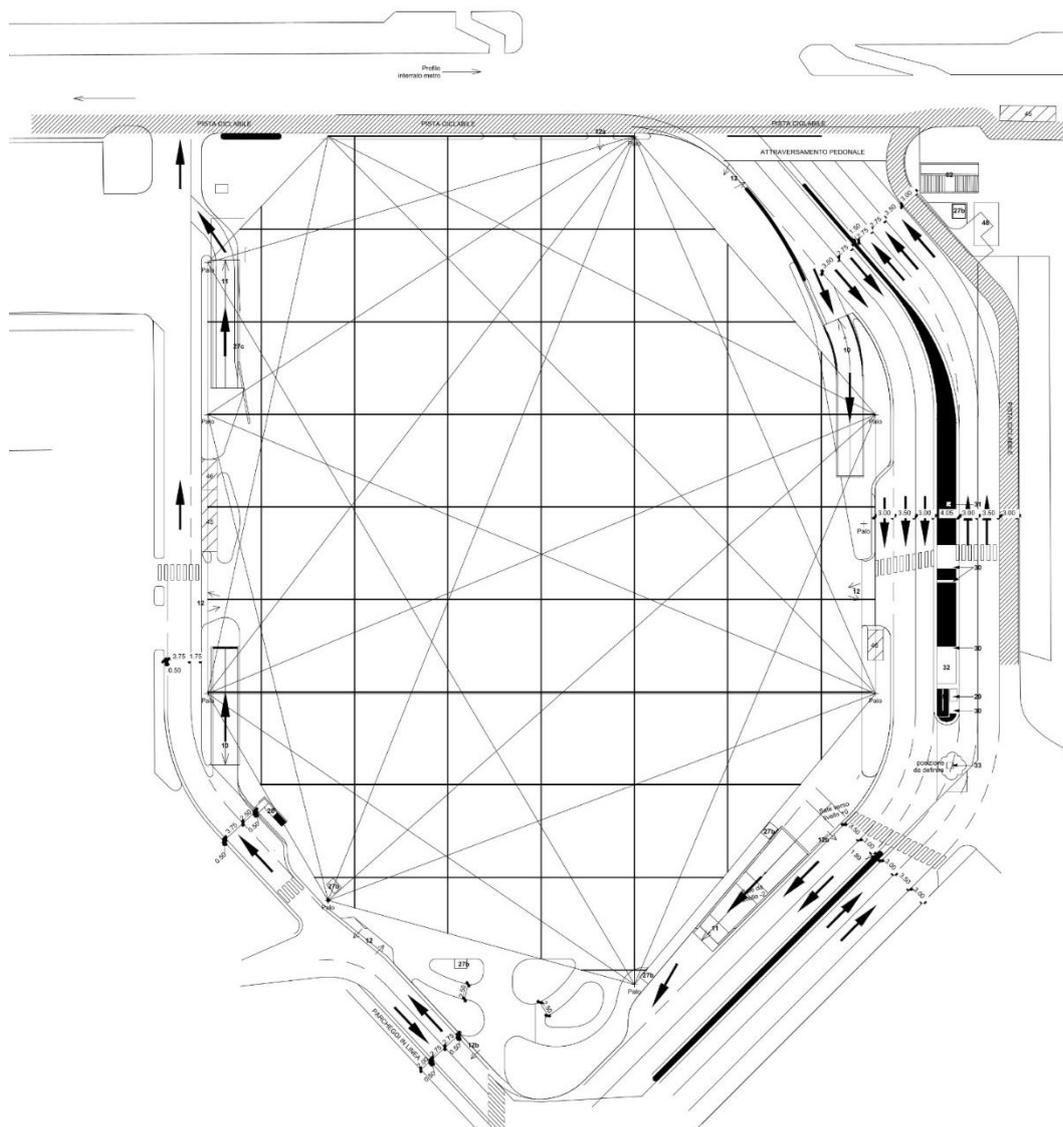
Progetto di illuminazione Piazza Bengasi - planimetria
